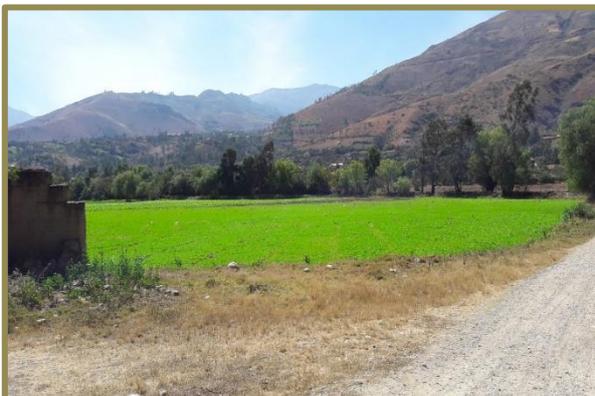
Vista de la topografía del terreno para el proyecto.
